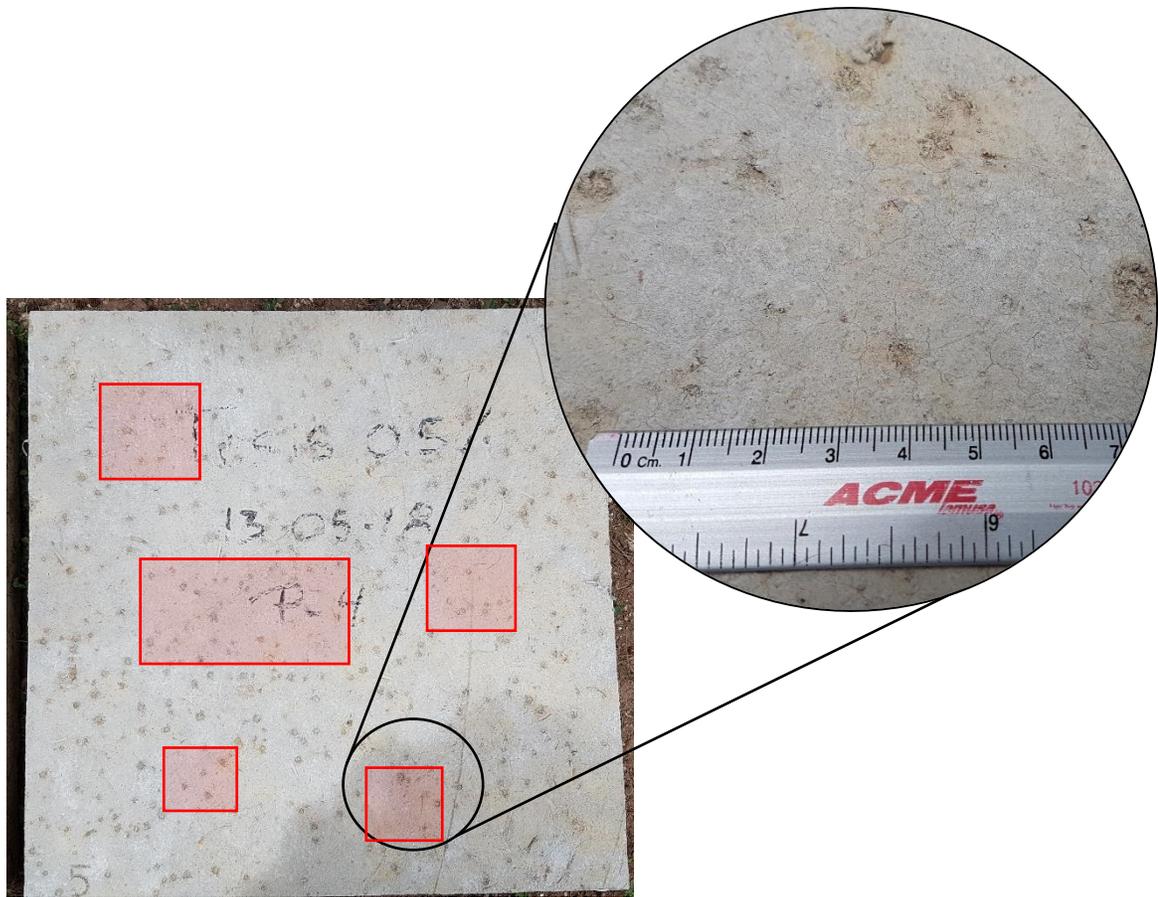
Losa CONCREPET con 0.50% de fibra, 20% fisurada a 21 días
